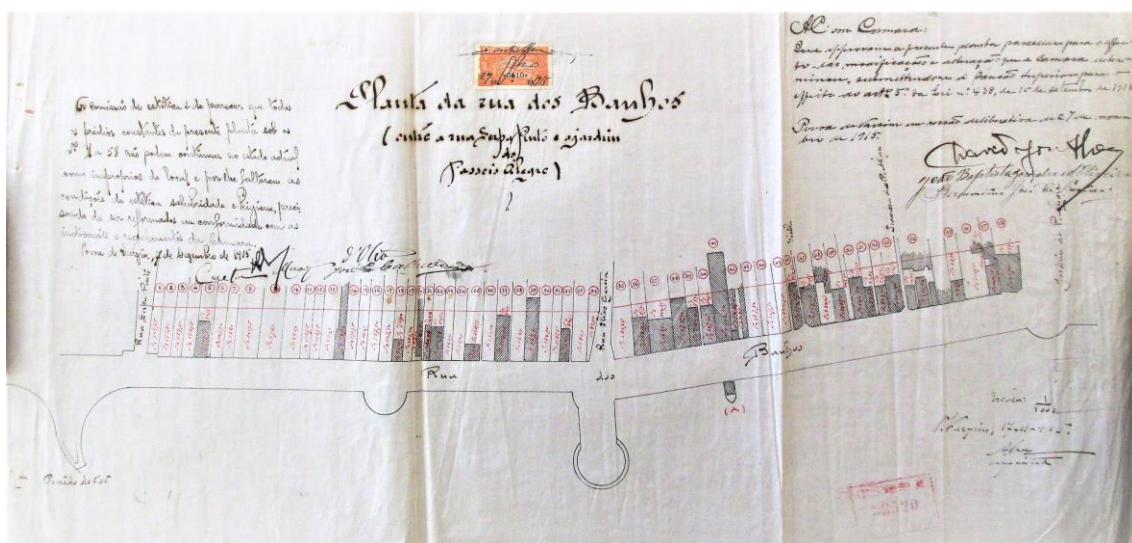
Reprodução digital da planta da Rua dos Banhos, AMPV, 1915.
